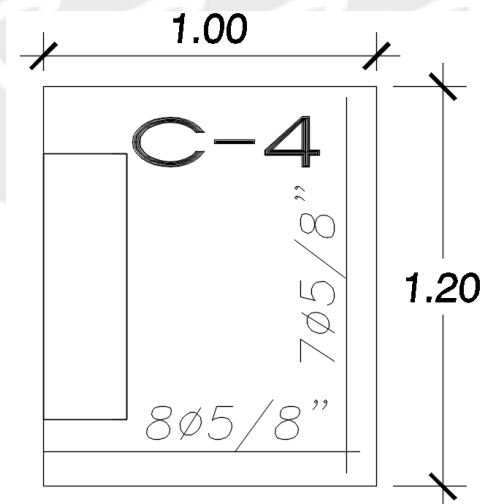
Barras de refuerzo de la zapata C-4
